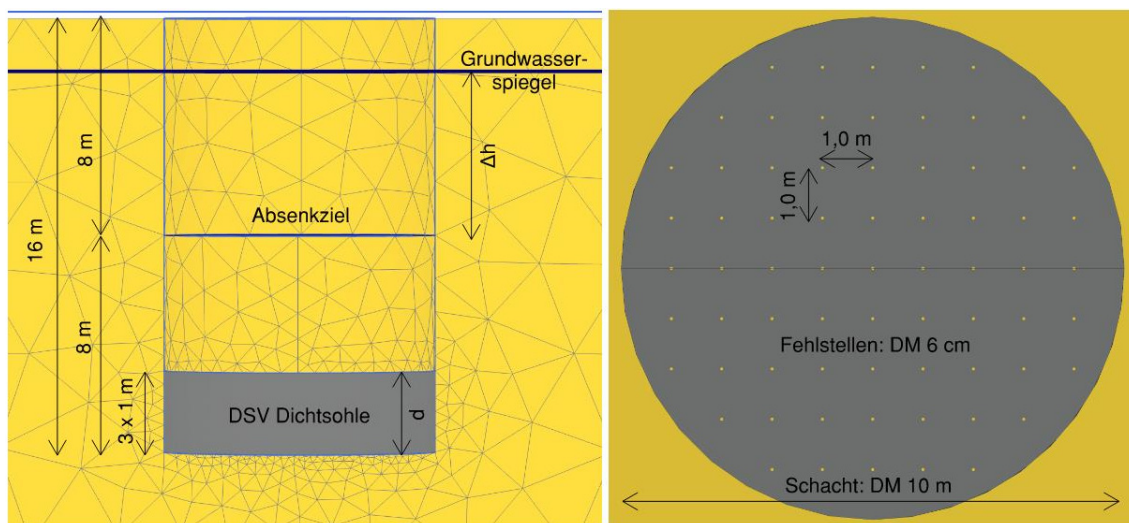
Numerisches Modell eines Schachtes zur Berechnung der Restwassermenge; Schnitt (links), Grundriss der Sohle mit vordefinierten Fehlstellen (rechts)
